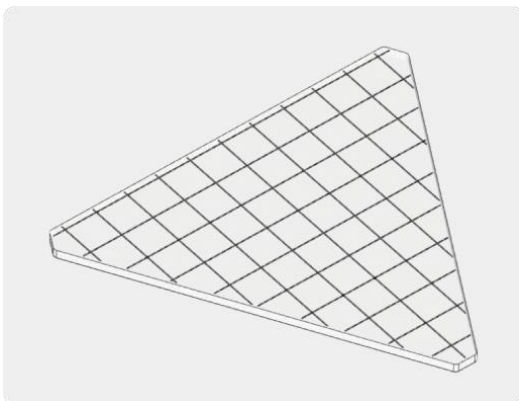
Malla electro soldada para reforzar el concreto.
